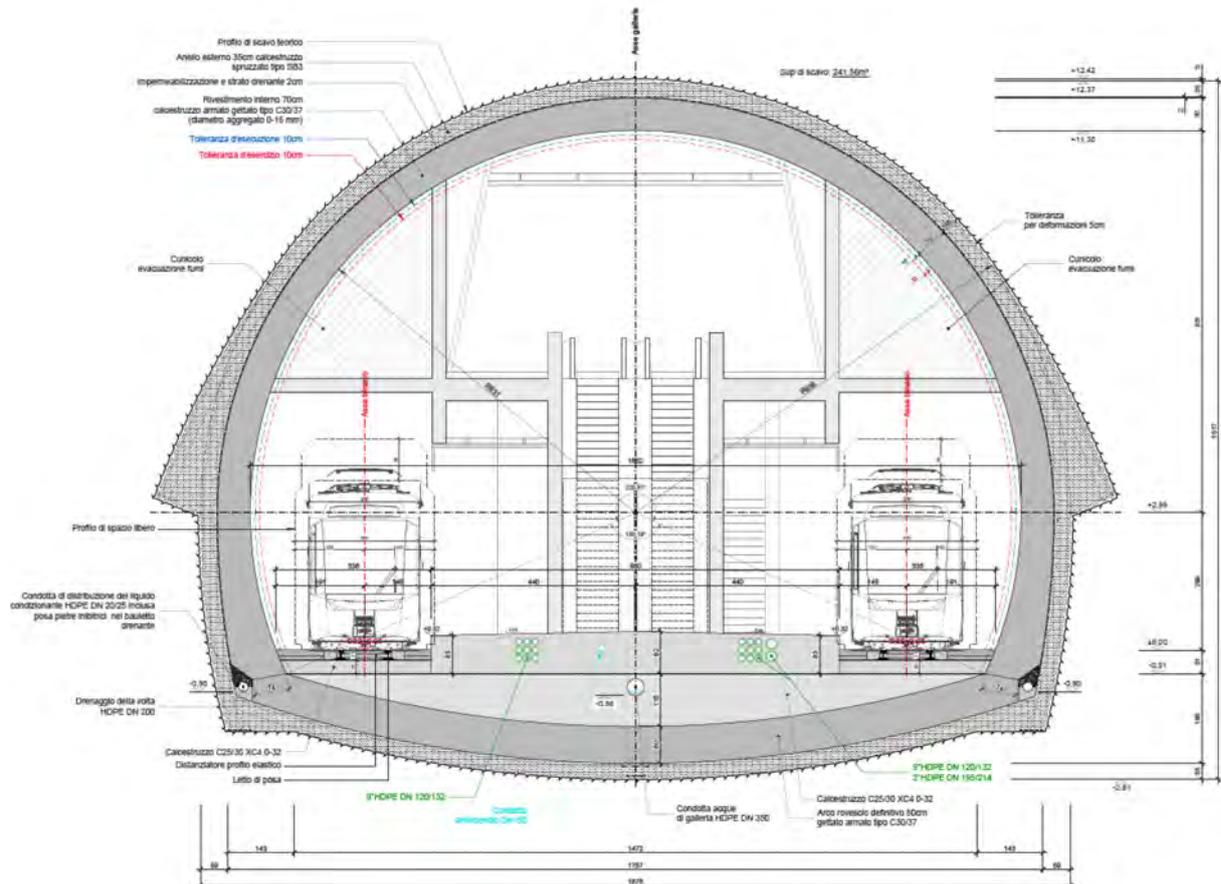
Sezione della galleria in corrispondenza della stazione sotterranea
